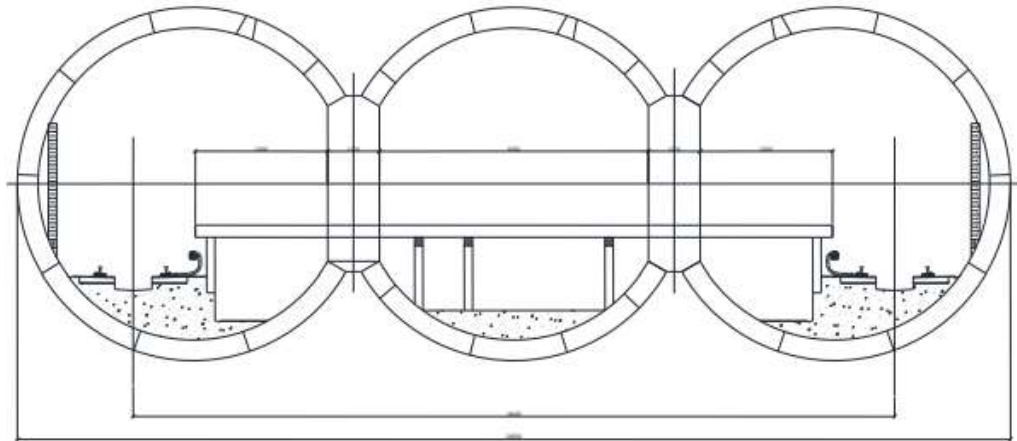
Колонна станція із залізобетону – блоки
